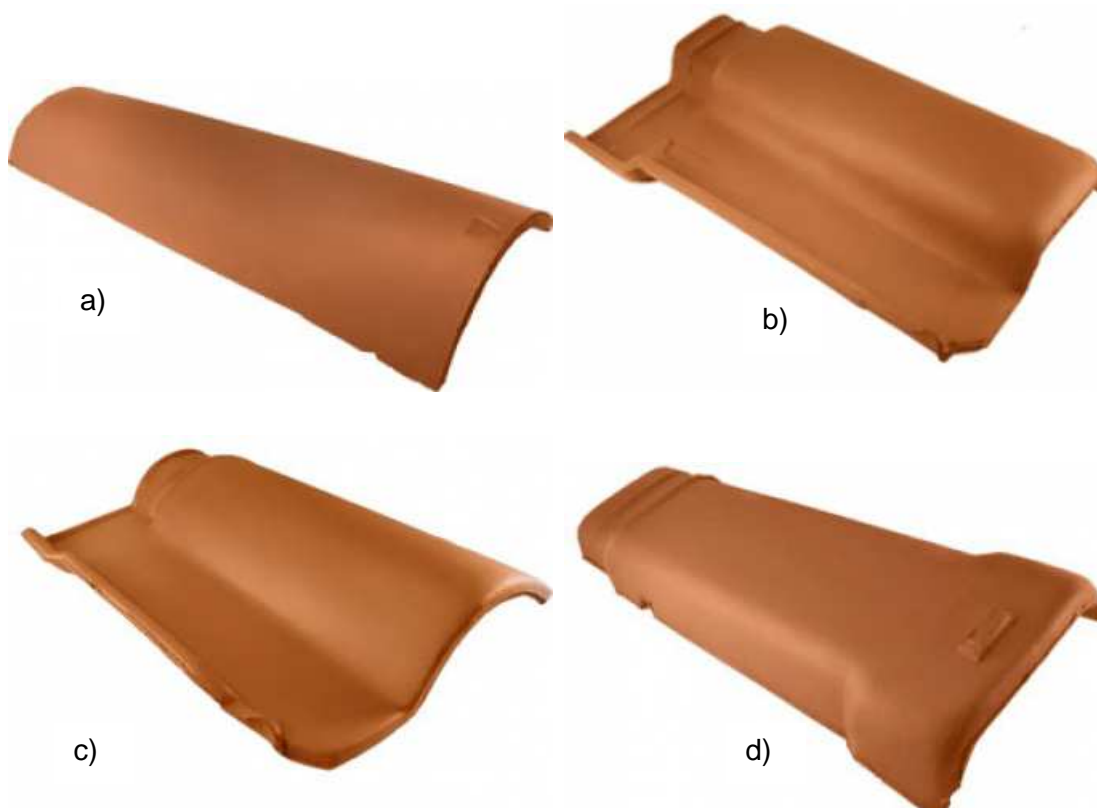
Tipos de telhas produzidas em Russas. a) extrusada, b) romana, c) americana, d) plan.
